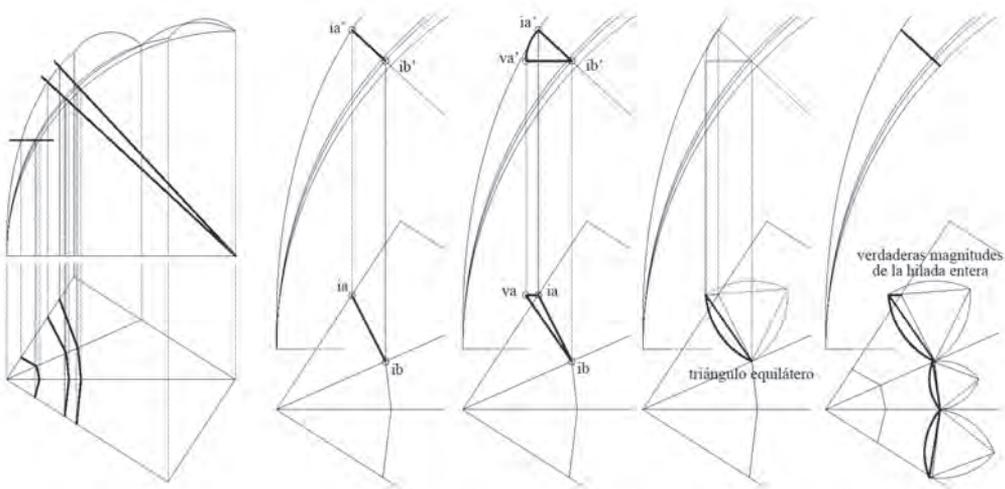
Imagen del trazado de las plementerías. A la izquierda las intersecciones de planos con aristas en planta, en el centro las verdaderas magnitudes, y a la derecha ejemplo de trazado de las curvaturas.
